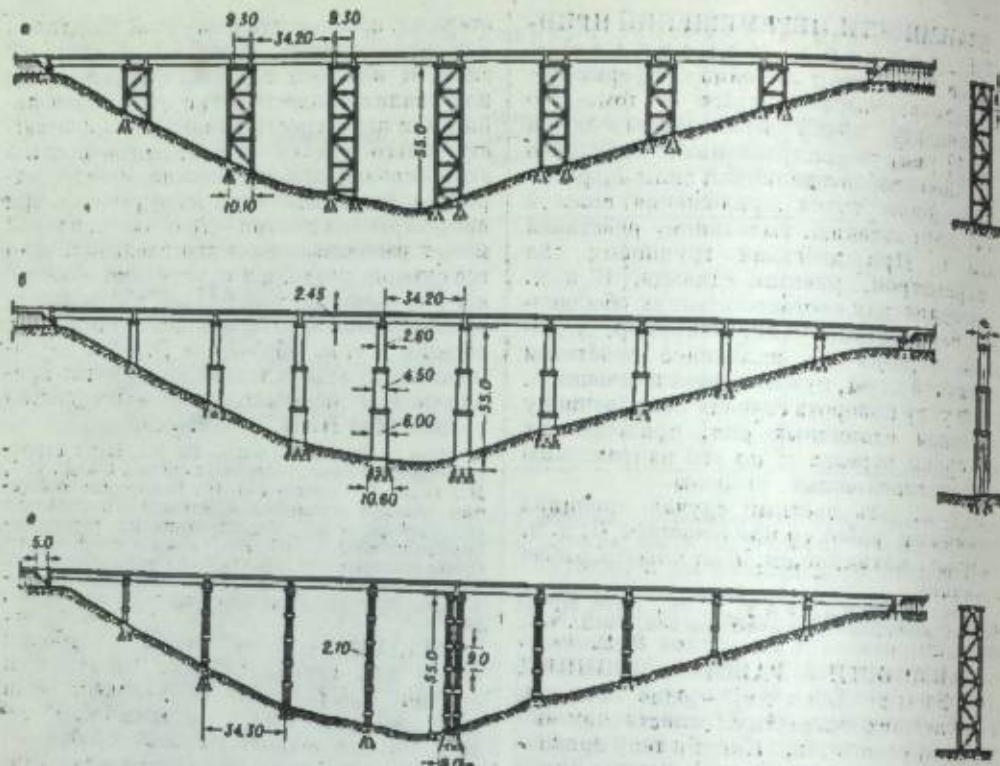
Схемы балочных сборных железобетонных виадуков (Гиротрансмост): а — с жесткими опорами на центрифужированных элементах; б — с жесткими предварительно напряженными опорами на пустотелых блоках; в — с гибкими опорами на предварительно напряженных элементах.
